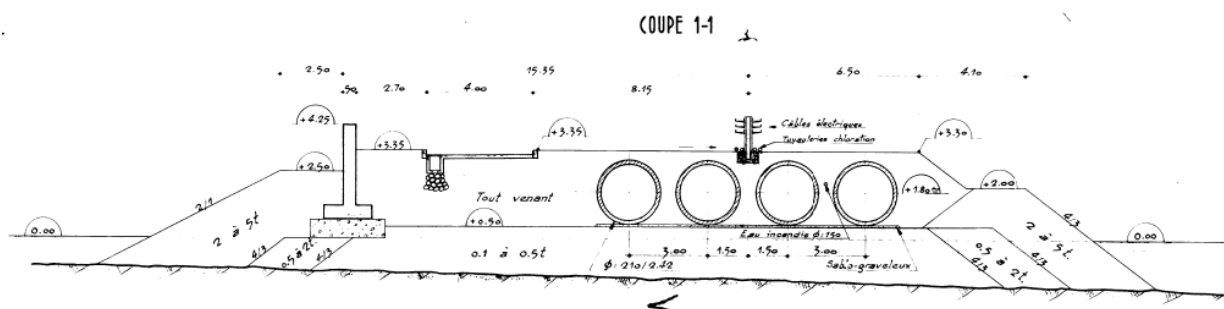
Coupe théorique A-A' de la digue de protection de la station de pompage, vue des prises d'eau, (voir la position sur le plan masse sur la figure précédente)
